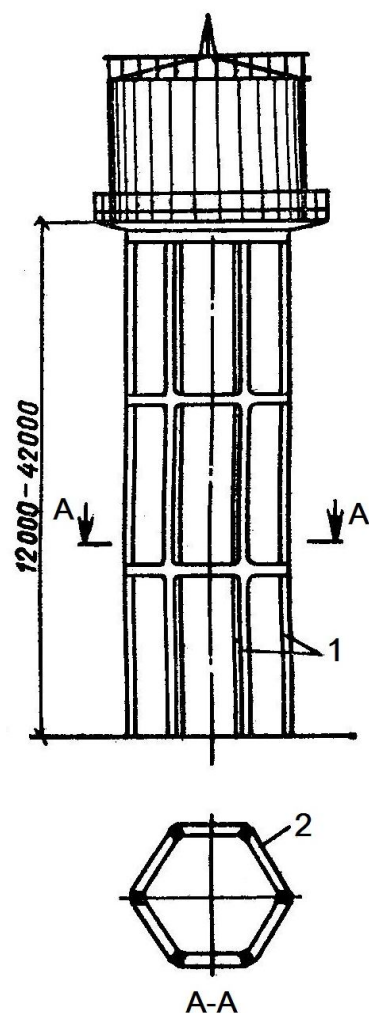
Водонапорная башня с опорой рамной конструкции:
